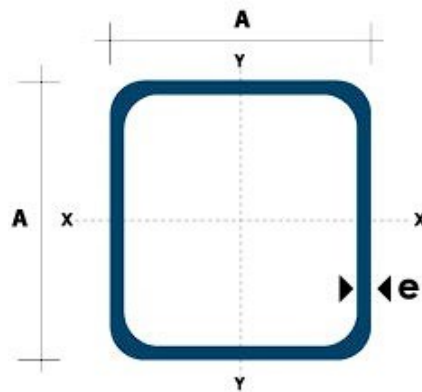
Dimensiones principales del tubo estructural cuadrado [46].
